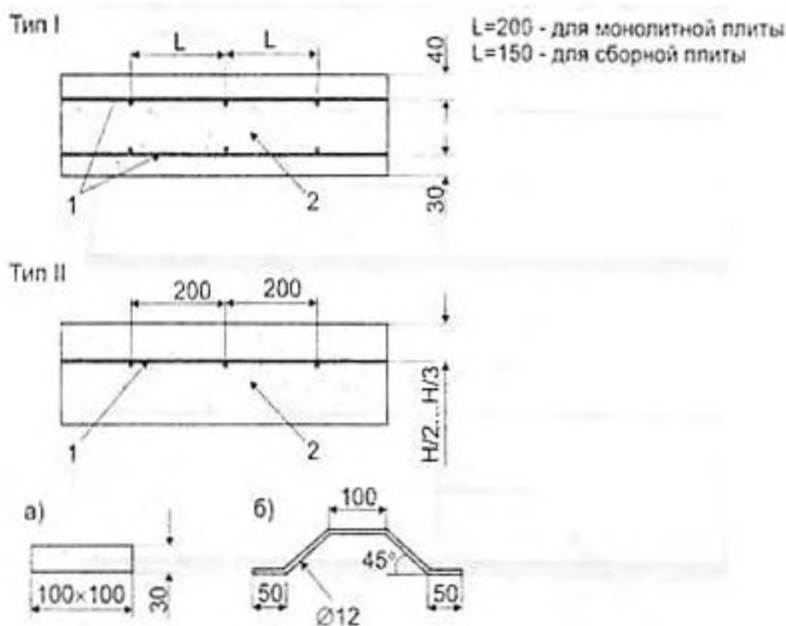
Схема армирования плиты: а - бетонная прокладка; б - монтажная скоба; 1-сетка из арматуры периодического профиля класса А-I, II, III диаметром 12-16 мм с ячейкой 200x200 для монолитных плит и 150x150 для сборных; 2-бетон класса не ниже Bbth 4.0 (марка М400)
